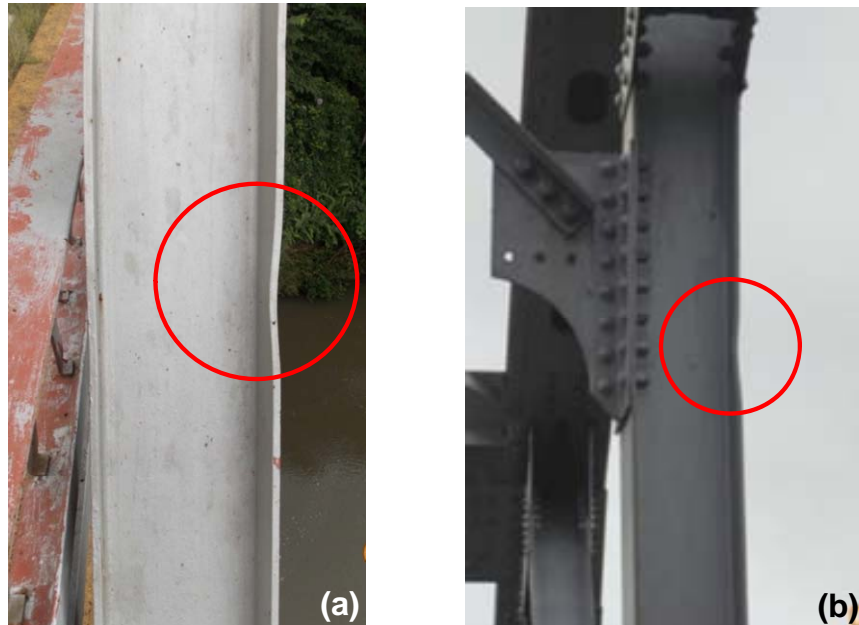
Elementos deformados en superestructura 1: (a) Elemento diagonal de armadura oeste; (b) Elemento vertical de armadura este.
